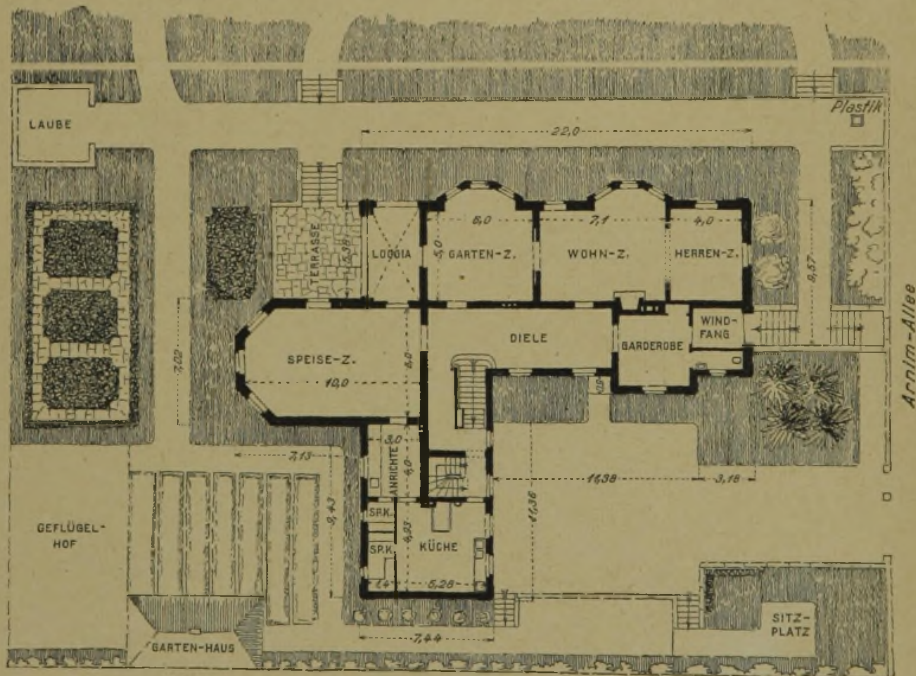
Grundriß des Erdgeschosses und Gartenplan.
